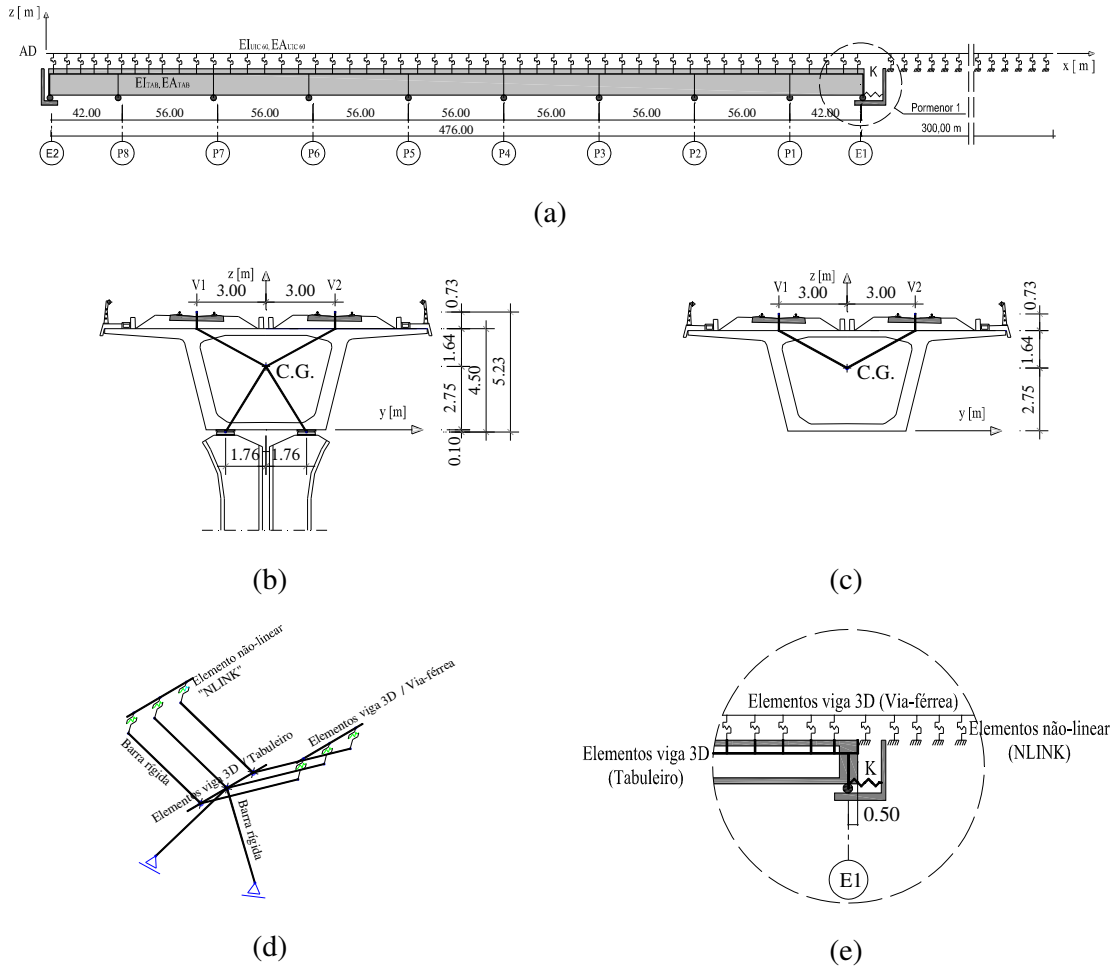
Modelo estrutural do sistema via – estrutura: a) alçado, b) corte transversal no apoio, c) corte transversal no vão, d) perspectiva parcial do modelo na zona do apoio e e) pormenor na zona do apoio fixo do tabuleiro
